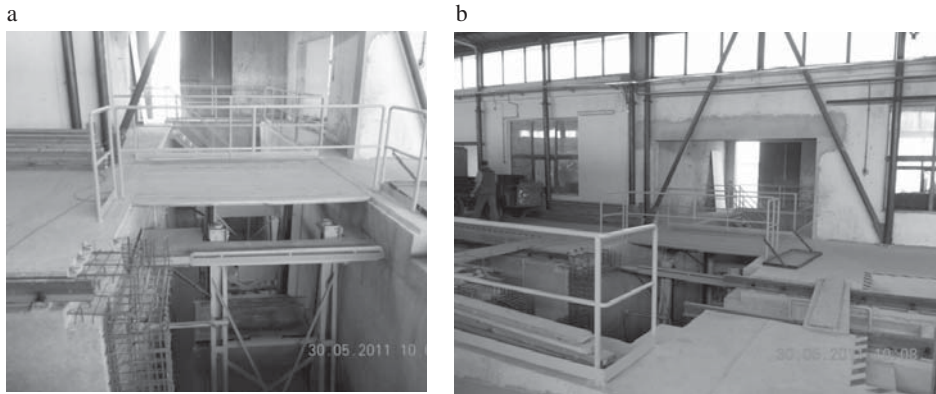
Konstrukcja wsporcza z zastrzałów rurowych w miejscu likwidacji istniejącego słupa hali, aby możliwe było wykonanie zapadni kolejowej
